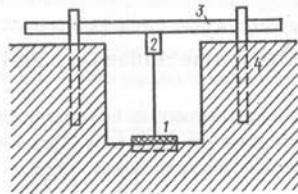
Схема установки для испытания грунтов опытной нагрузкой:
